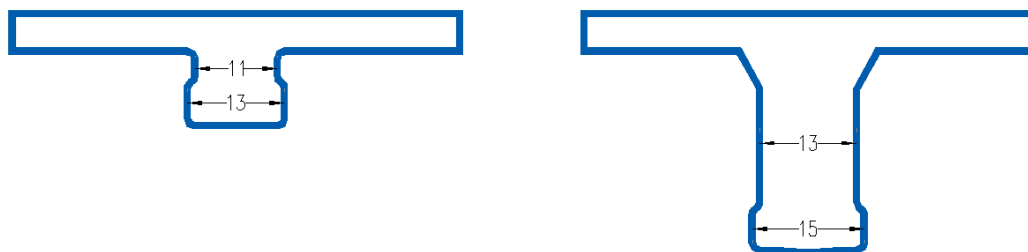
Sección transversal de concreto con medidas en alma. (Elaboración propia)
